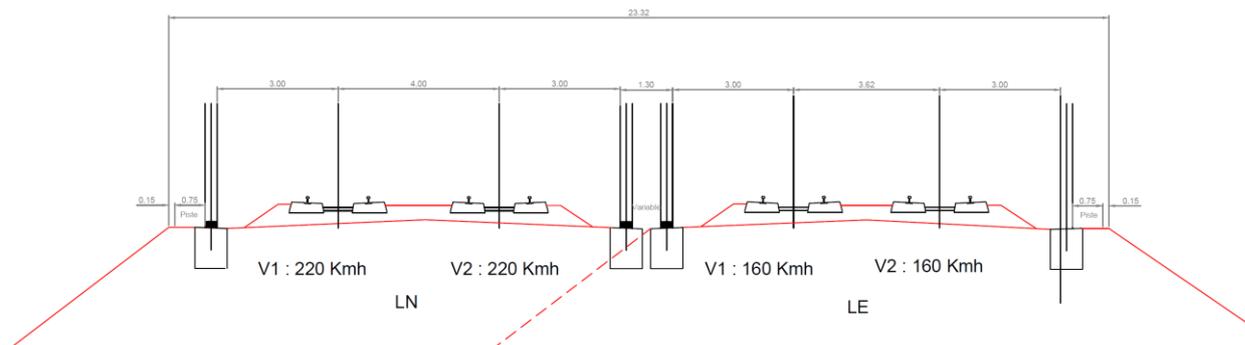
exemple de profil en travers pour une mise à 4 voies avec poteaux caténares
